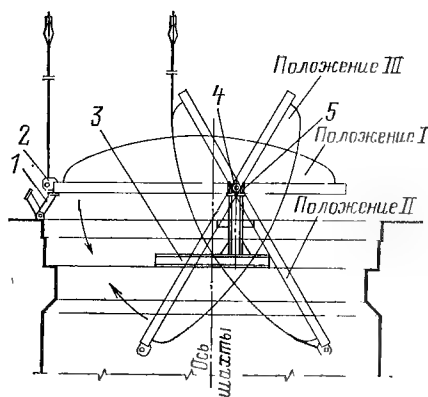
Схема кантовки днища страховочного кожуха.
